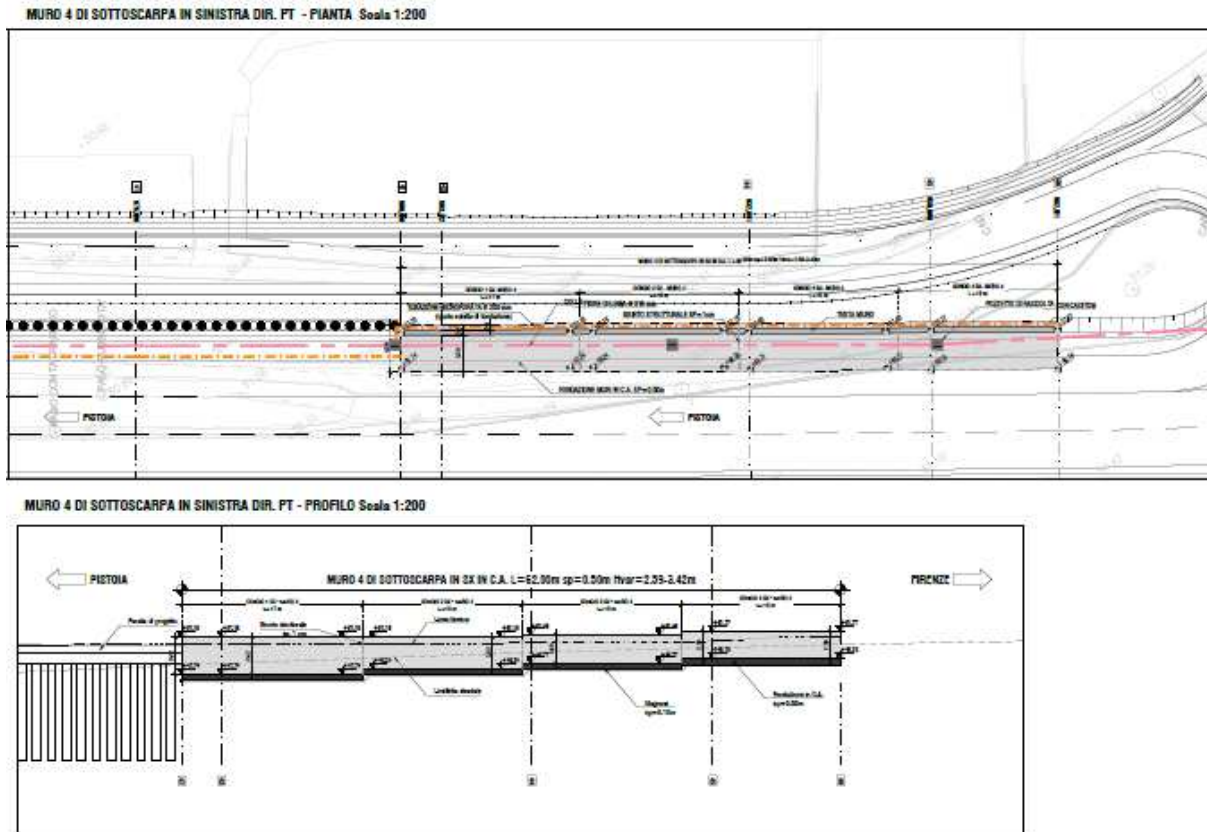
Stralcio planimetria e prospetto muro Asse SX
